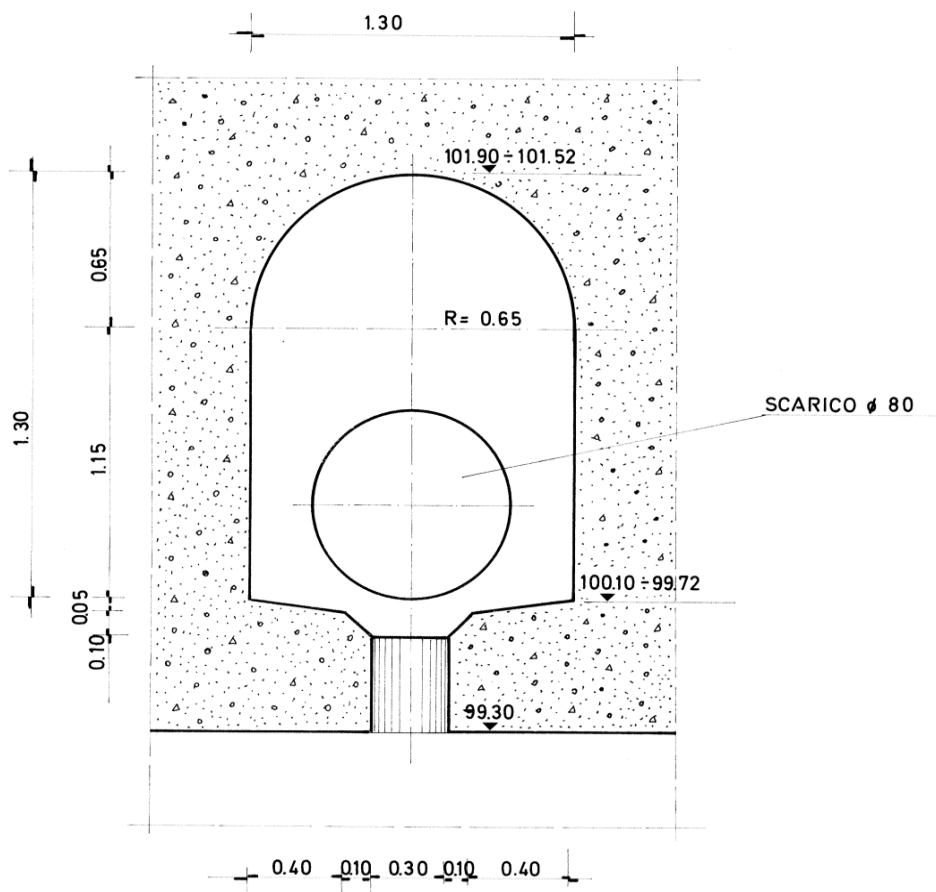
allegato 32 – Sezione cunicolo di ispezione e drenaggio
